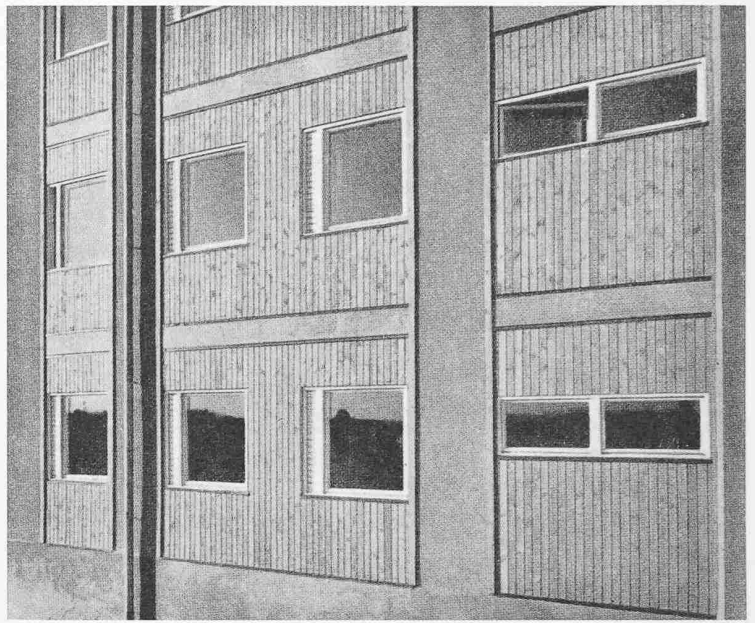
Detail der Ostfassade mit Ventilationsöffnungen
